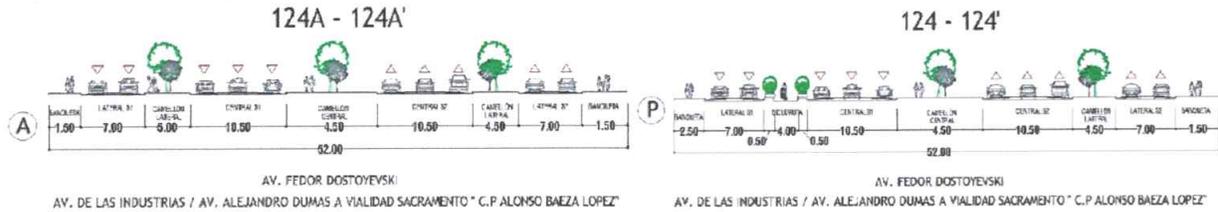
Sección vial actual y futura Av. Fedor Dostoievski. Fuente PDU 2040 vigente.
